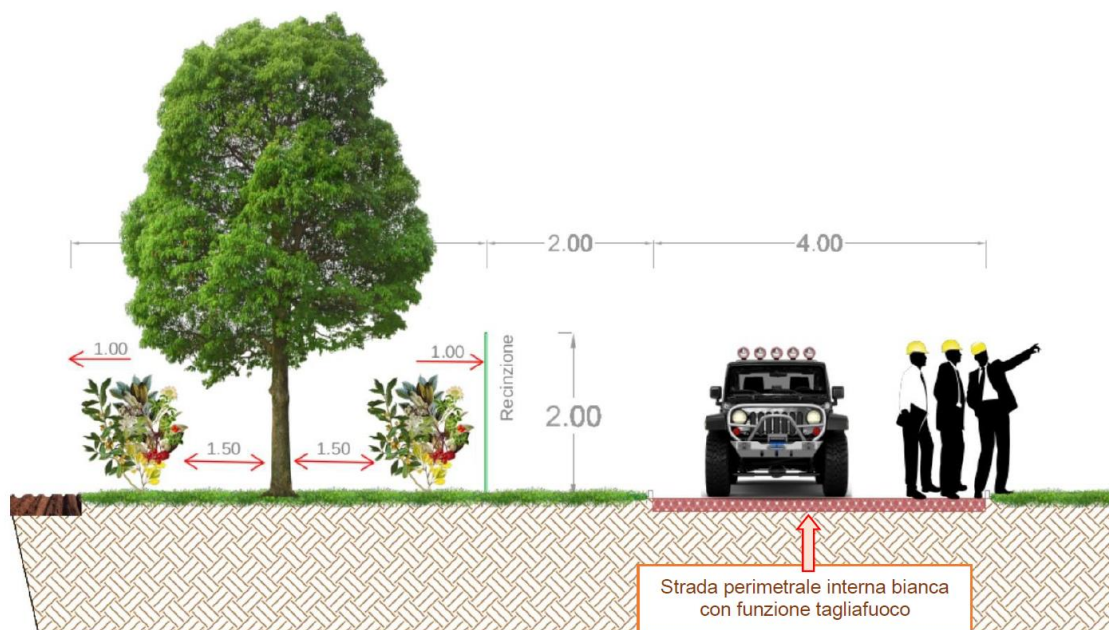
Sezione tipo della fascia tampone perimetrale
